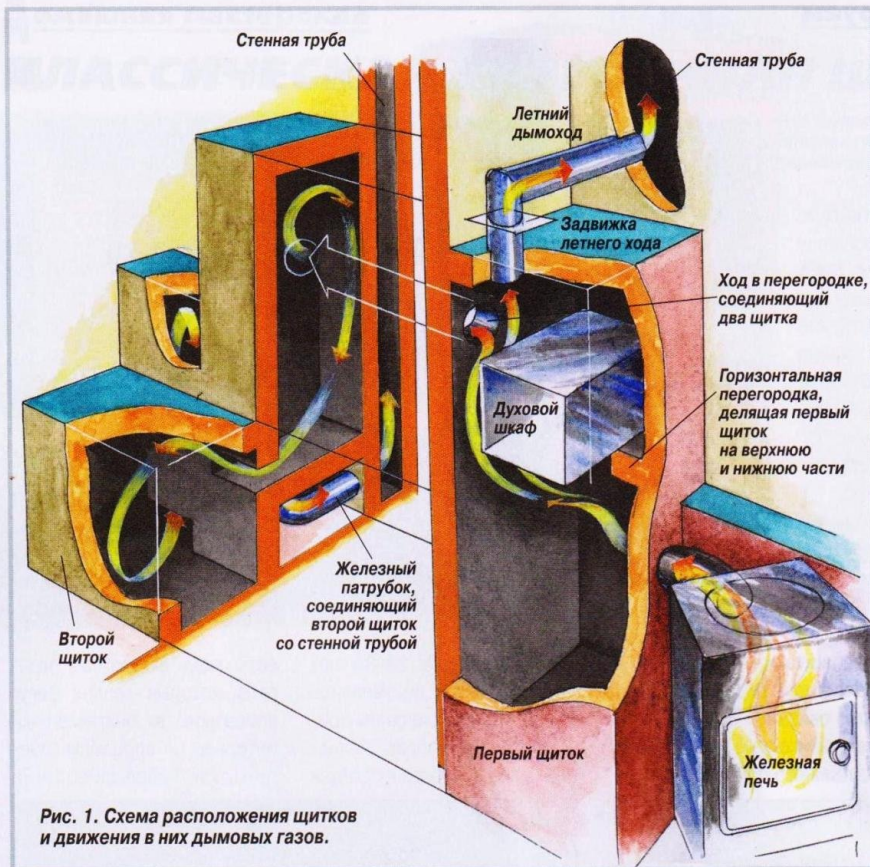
Схема расположения щитков и движения в них дымовых газов.
